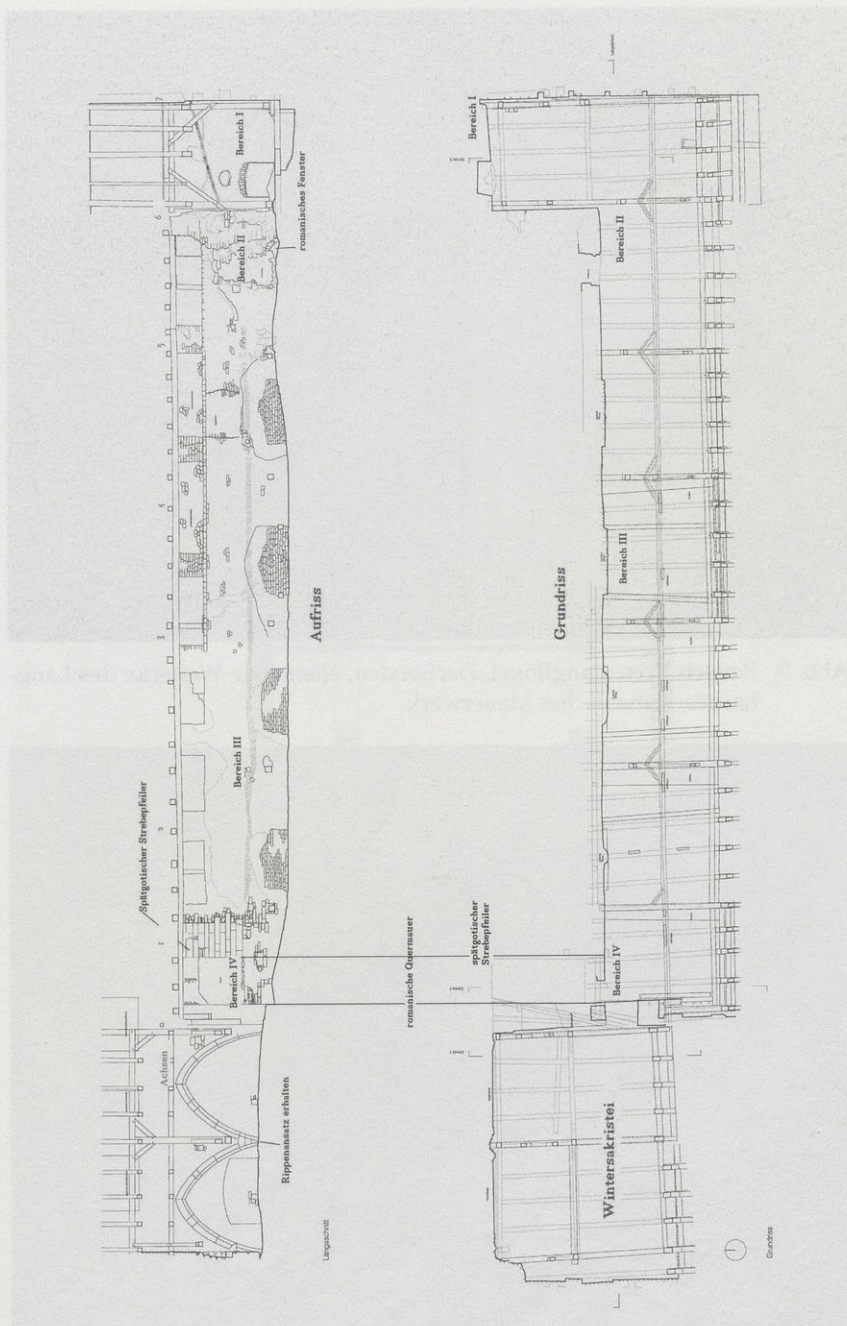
Grund- und Aufriss, Nordseite Dachraum
